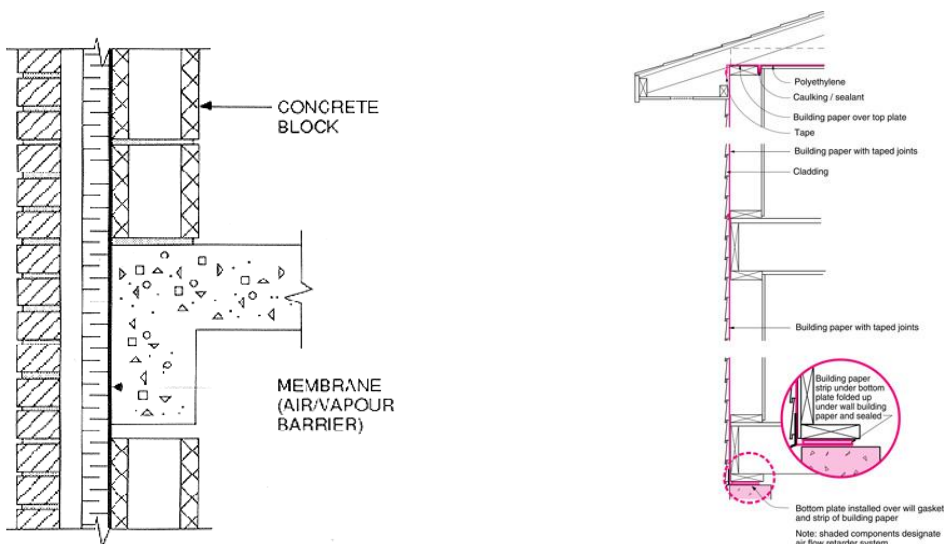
Detalle de estanqueidad tipo de distintos sistemas constructivos.
